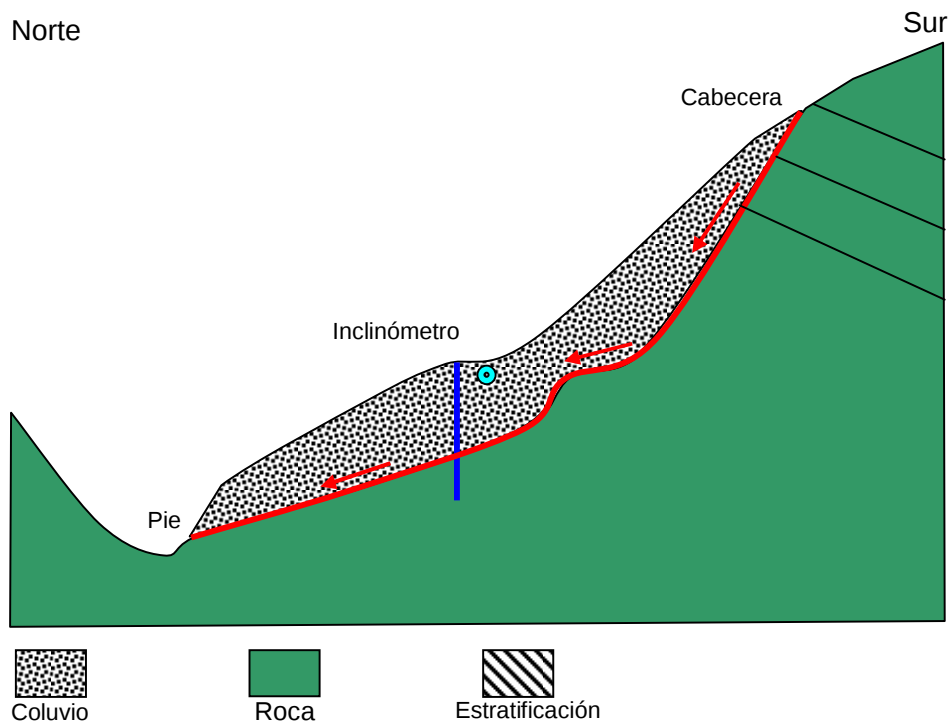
Instalación típica de un inclinómetro-Anclaje del extremo inferior
